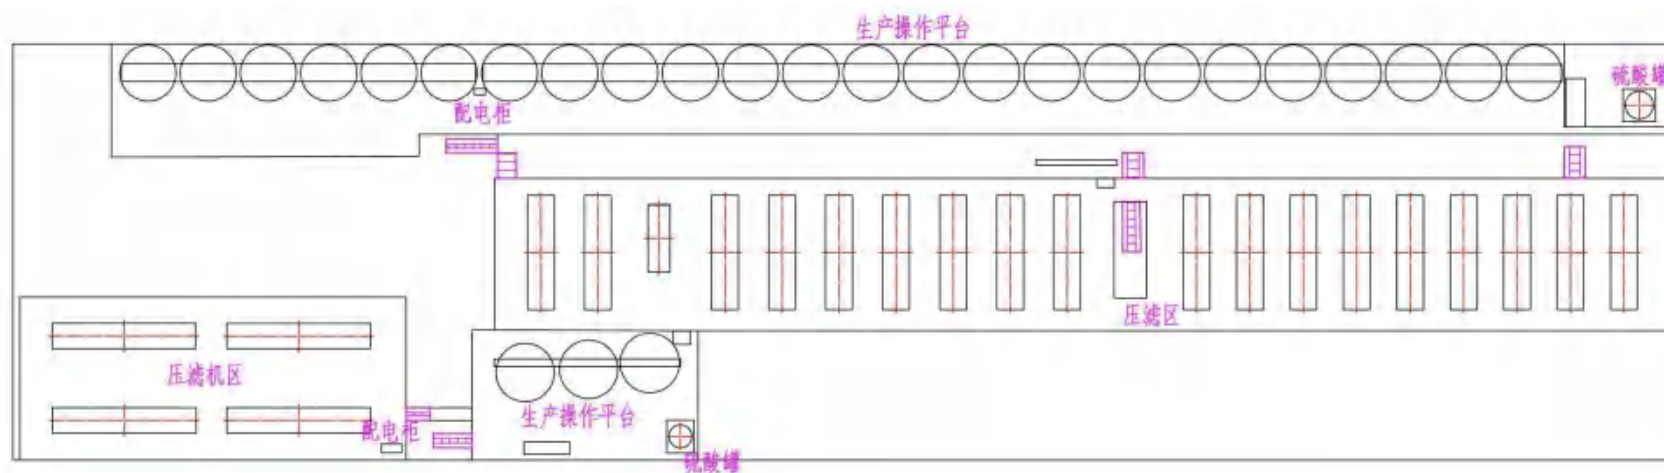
浸出一车间设备设施平面布置图 (2 楼)
